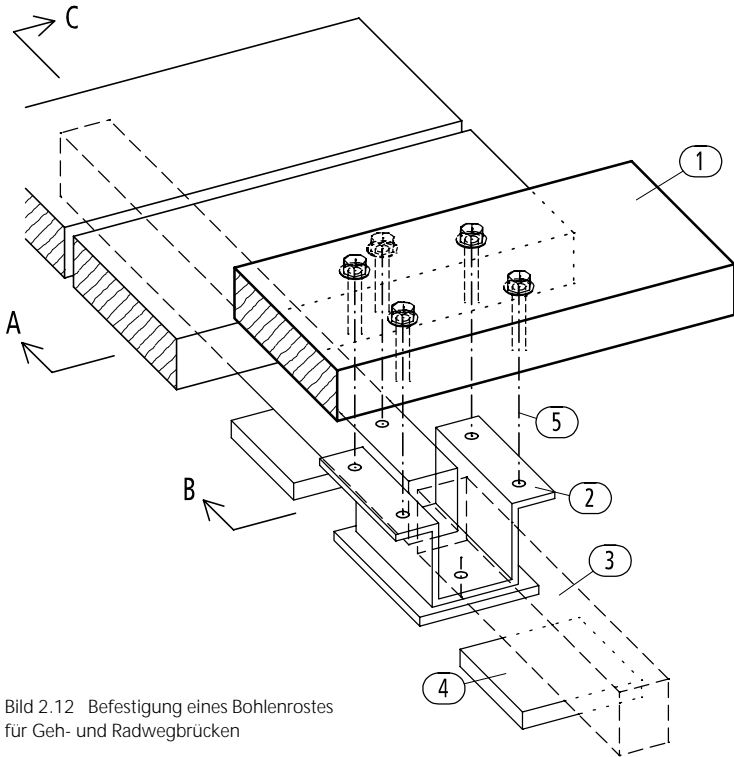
Befestigung eines Bohlenrostes für Geh- und Radwegbrücken
